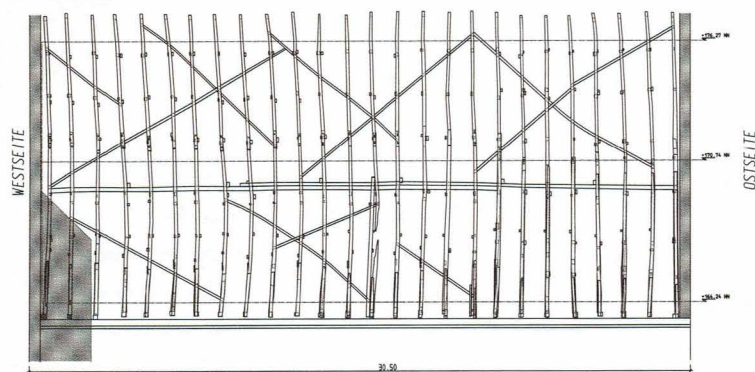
Längsschnitt durch das Dach mit nach dem 2. Weltkrieg eingebauter, unwirksamer Mittelpfette
